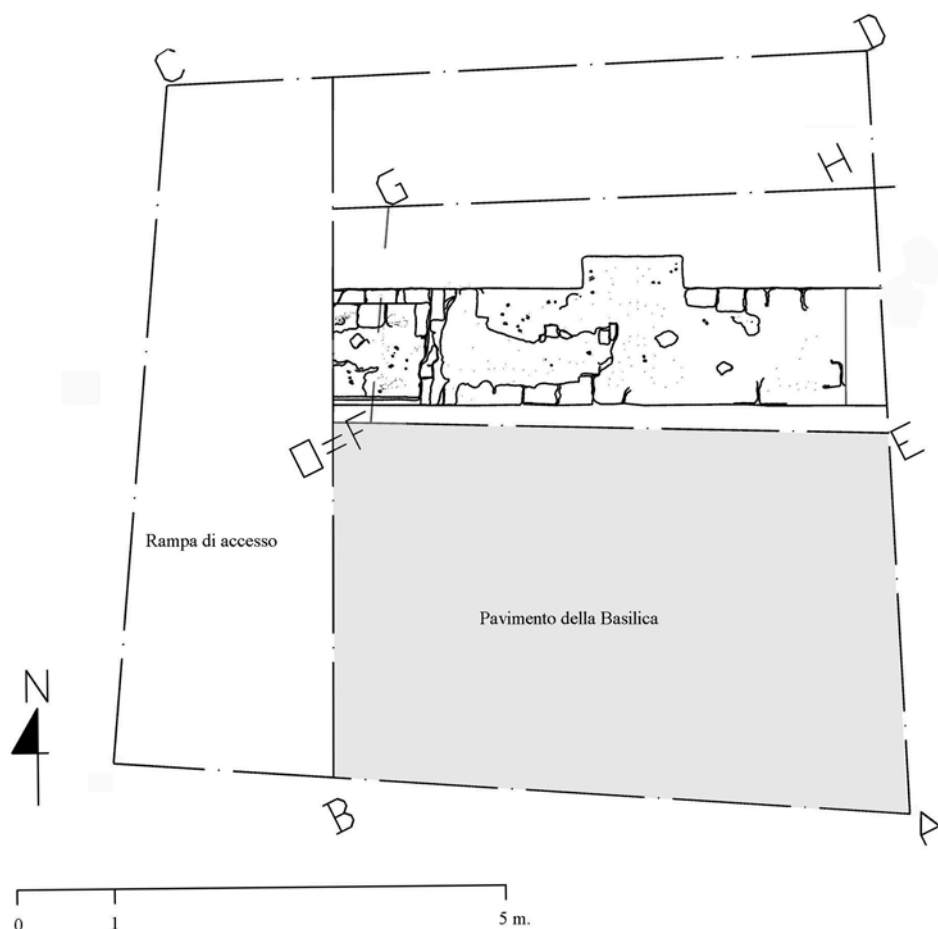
Planimetria del saggio 2 (2008), con in evidenza le strutture del muro perimetrale nord della basilica.
